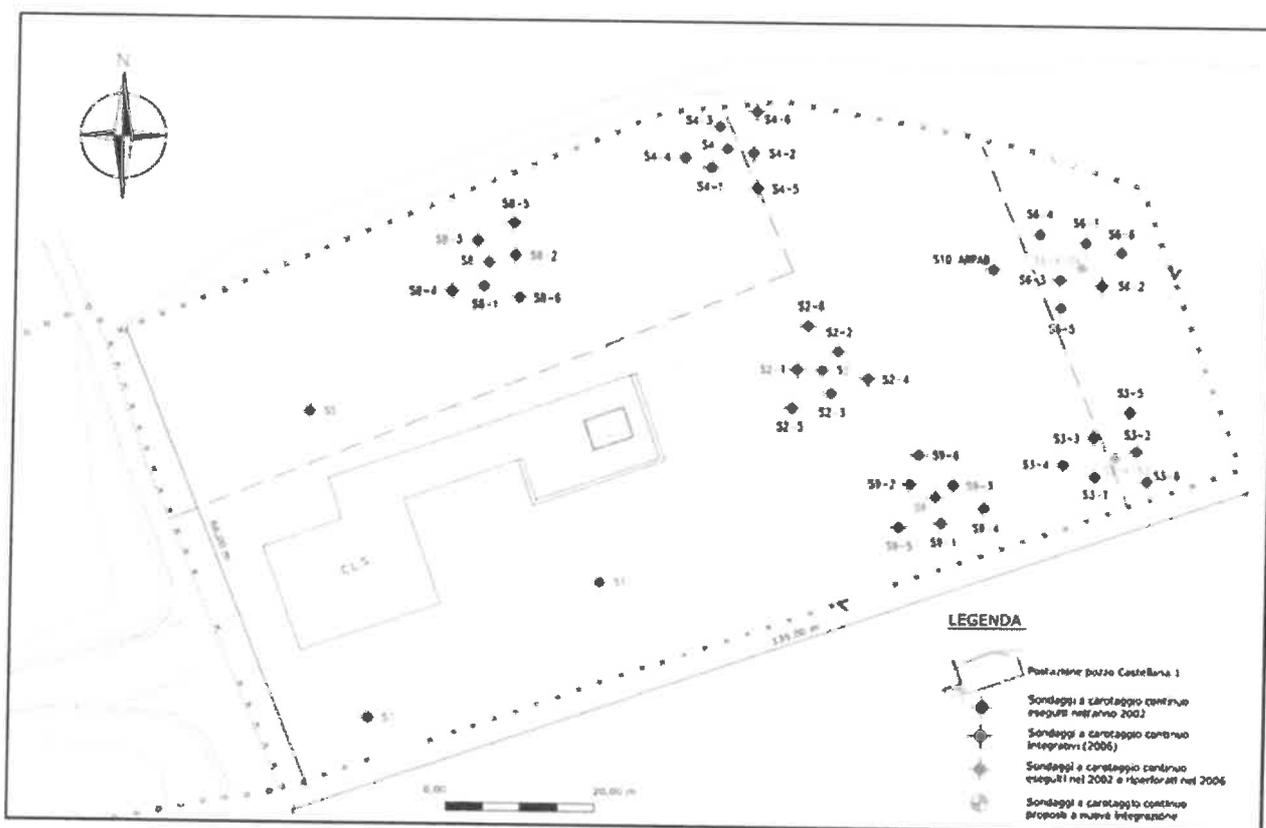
Planimetria dell'area con ubicazione sondaggi e legenda
